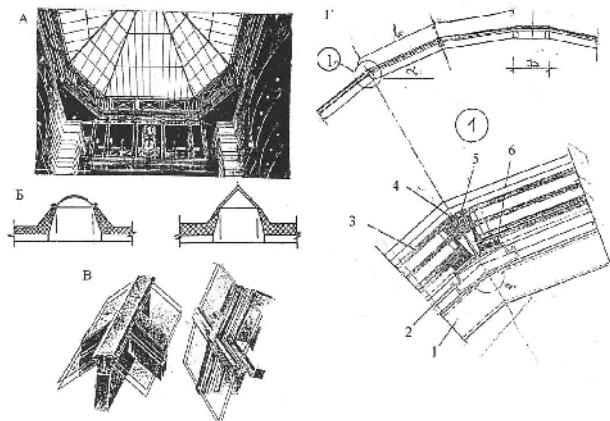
Светопрозрачные конструкции покрытий: А - общий вид интерьера атриума; Б - схемы фонарей покрытия; В - обиде виды конькового и бокового узлов покрытия; Г - сечение по конструкции покрытия овальной фермы; 1 - несущий стальной ригель; 2 - прогоны; 3 - двухкамерный стеклопакет; 4 - мастика; 5 - уплотнители; 6 - утепляющая прокладка
